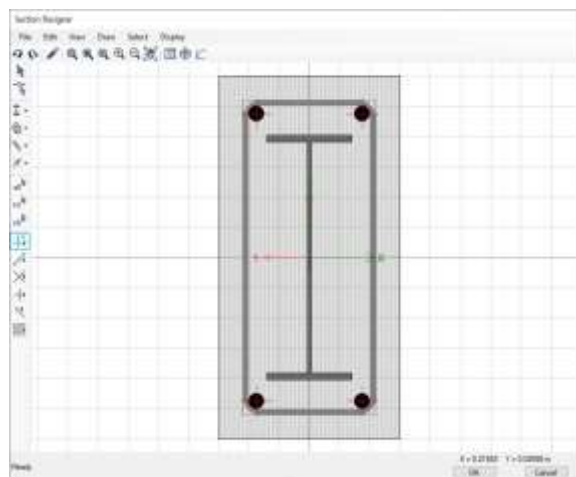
Definición de columna de 30x60 reforzada con perfil metálico H
